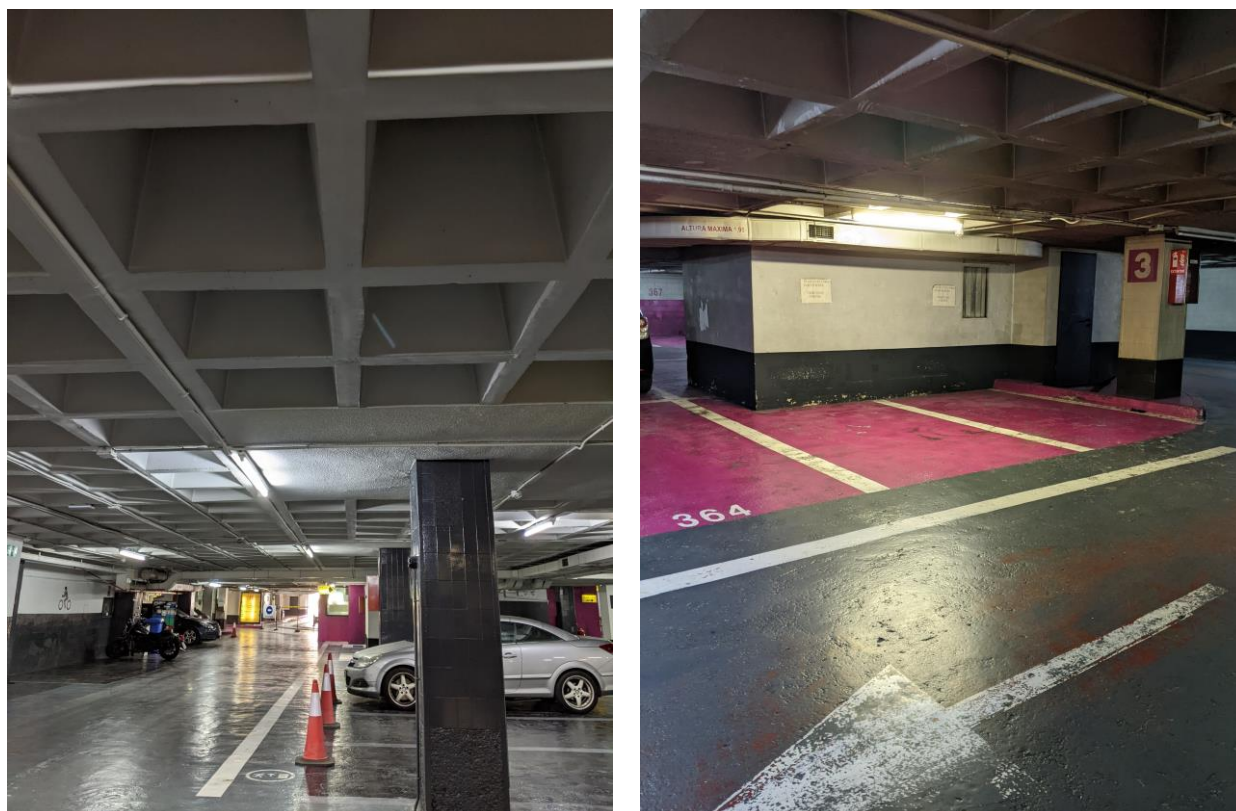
Definición del forjado de cubierta según proyecto de estructuras
